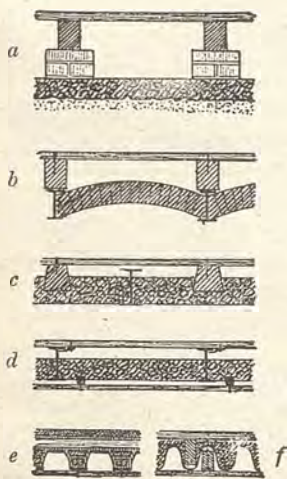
Disposizioni diverse pei pavimenti intavolati.
